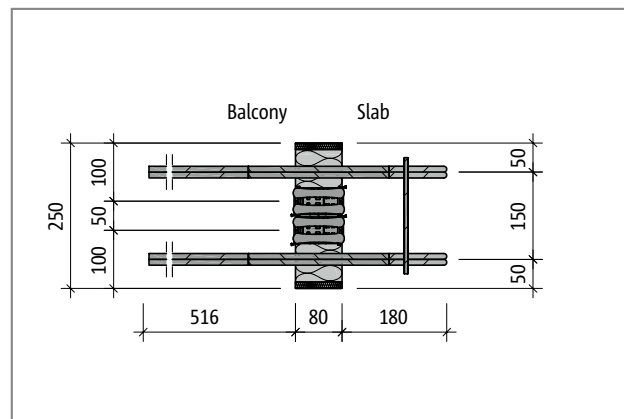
Schöck Isokorb® T type Q-E-W-VV5: Product layout
